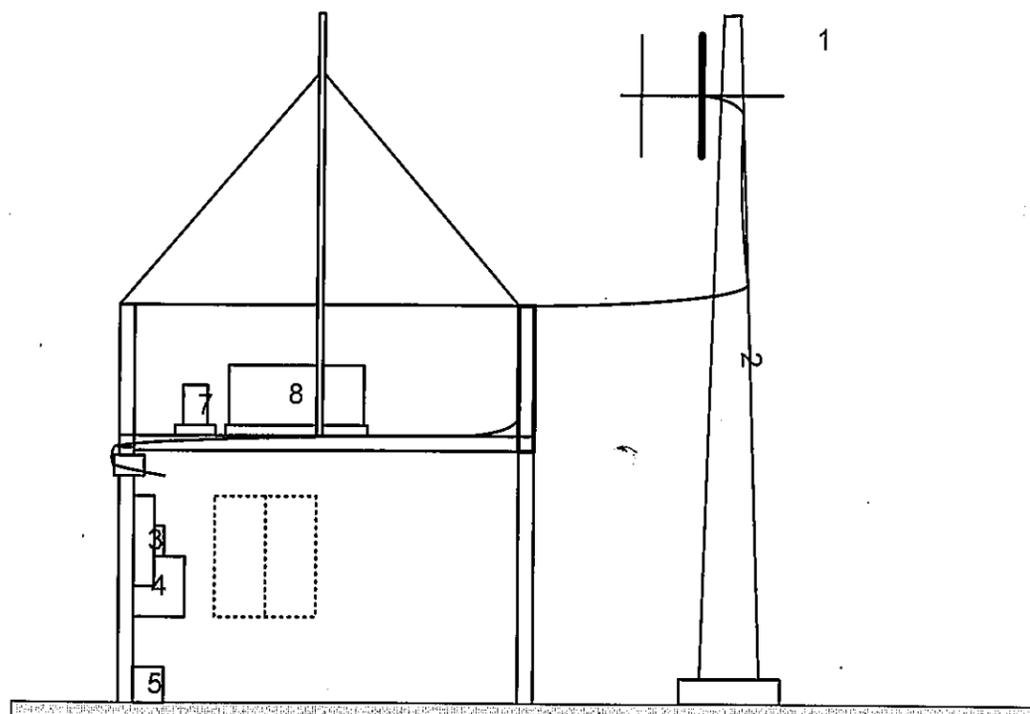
PLAN D'AMENAGEMENT DES EQUIPEMENTS
